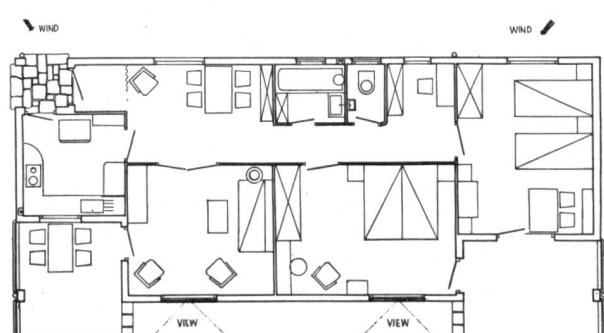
Grundriss eines Dreizimmerhauses, mit gleichen Vorbedingungen wie bei Abb. 10.
